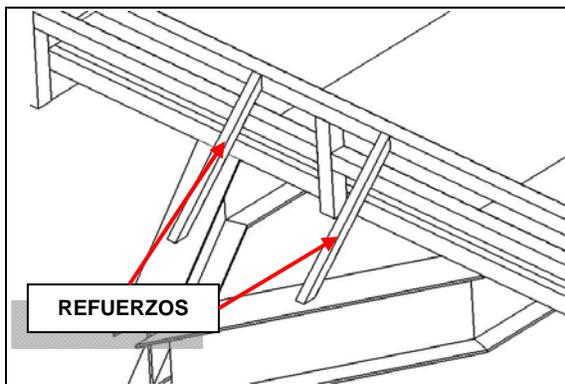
Propuesta para refuerzo de portería delantera.
